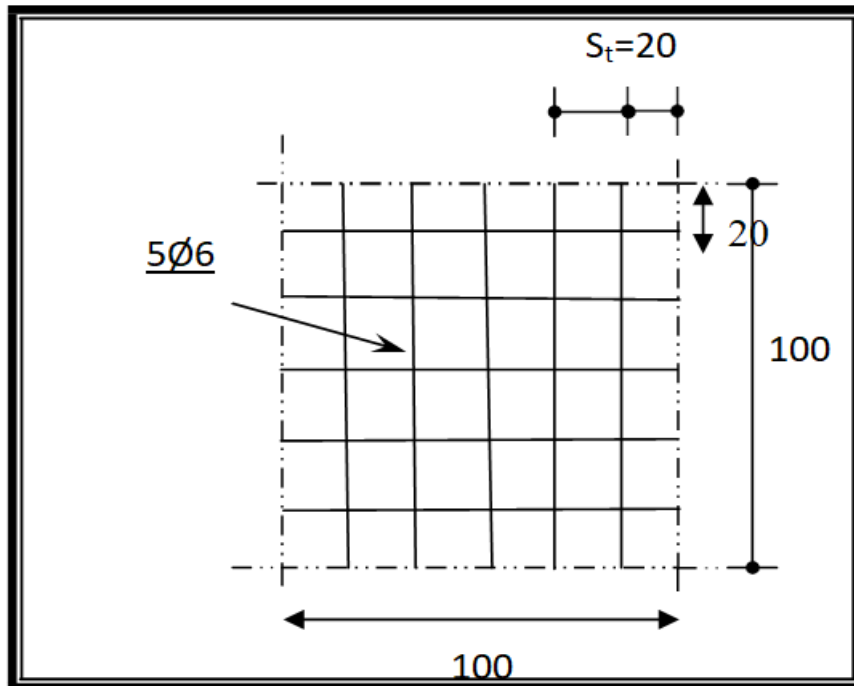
Disposition constructive des armatures de la dalle de compression
